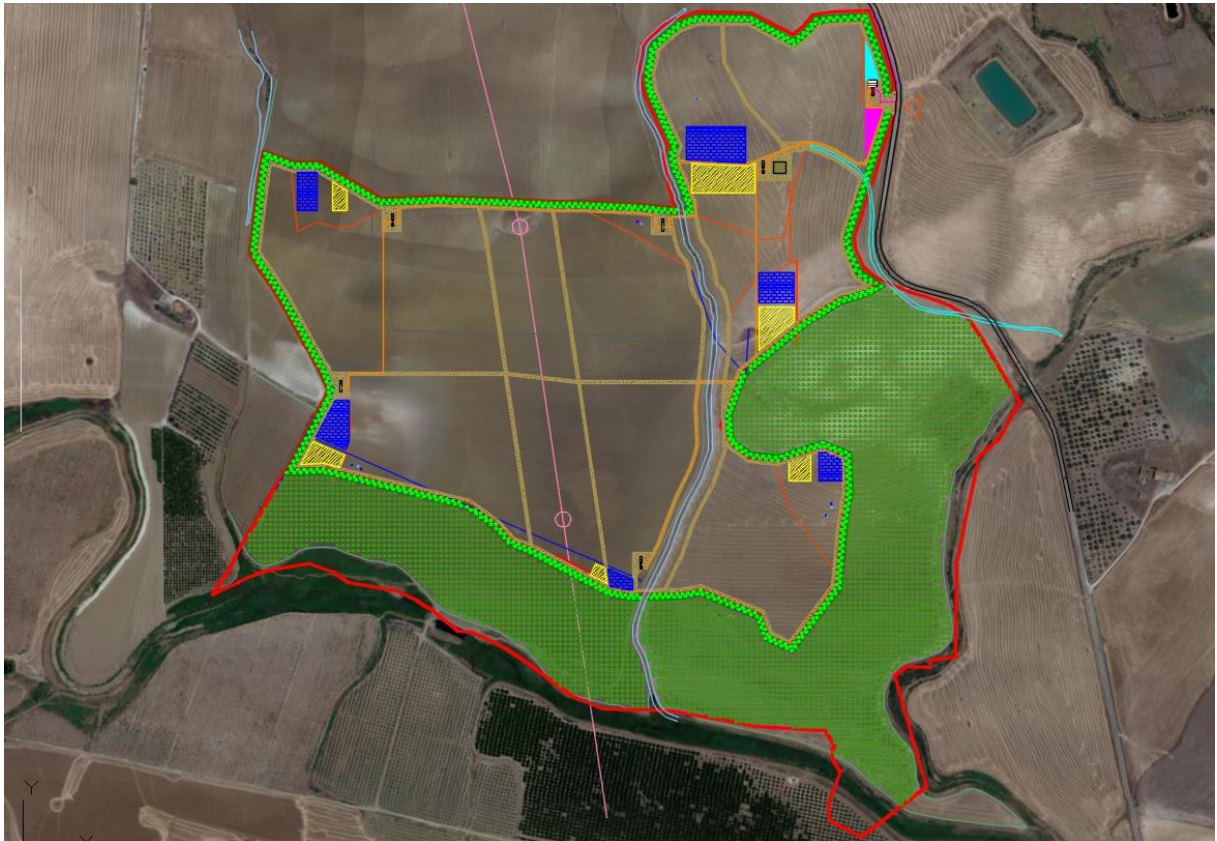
Piano di cantierizzazione lotto Sud con Individuazione dei punti di stoccaggio
